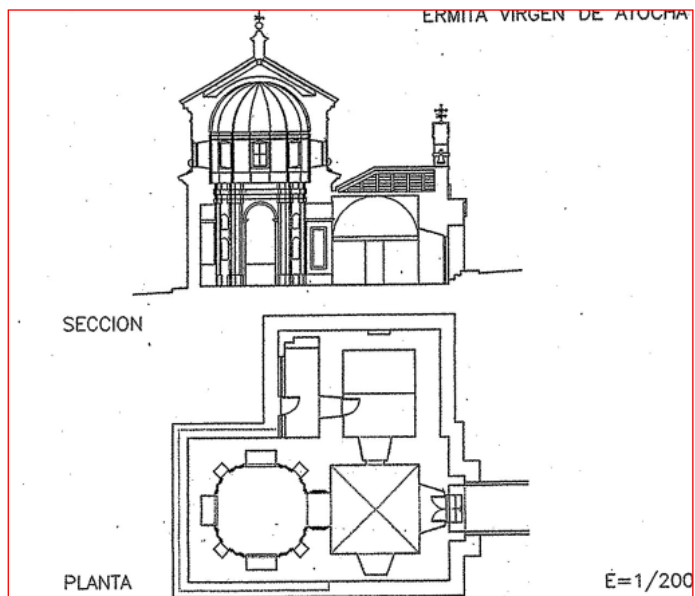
Ermita Ntra. Sra. de Atocha. Planos de sección y planta. Estado actual.
